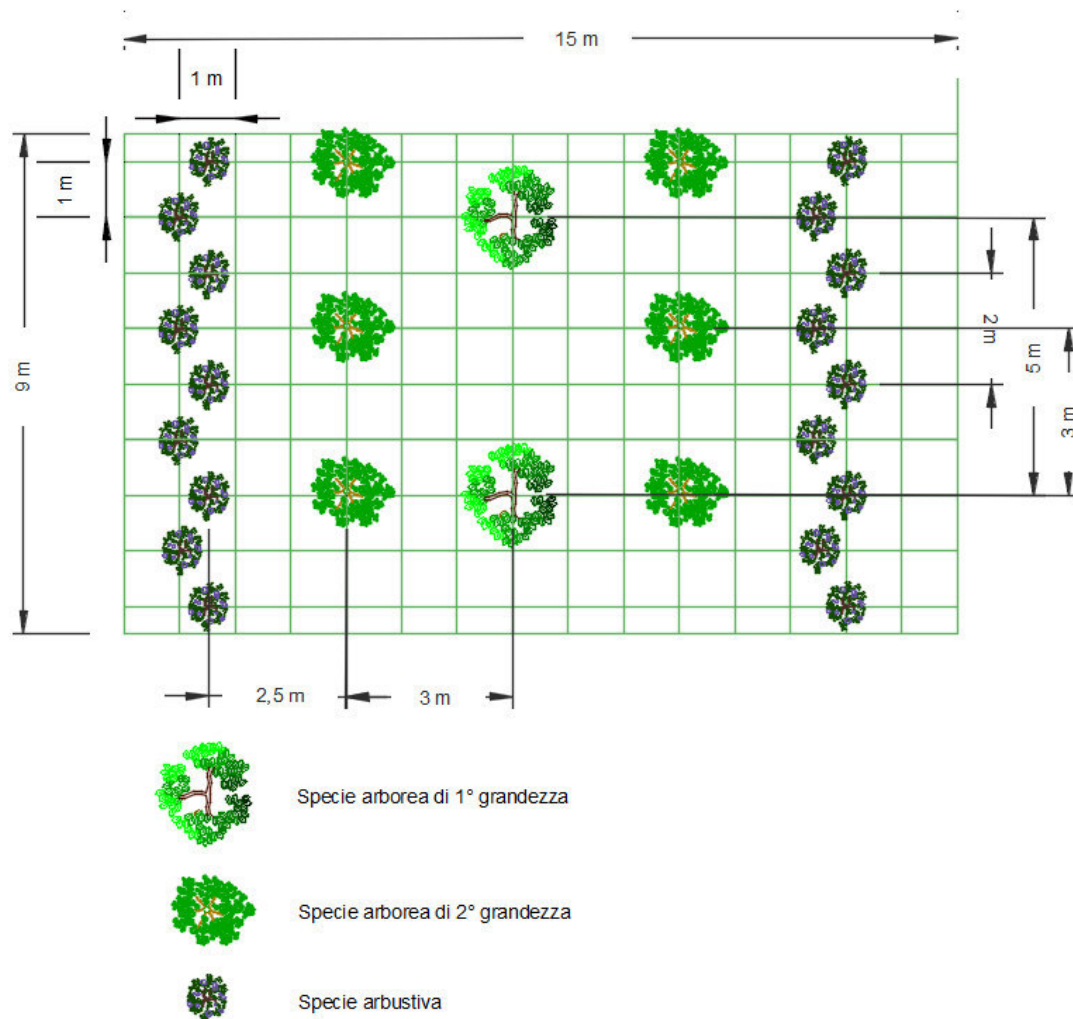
Modulo e sesto d'impianto della fascia schermante con struttura "a tetto"
